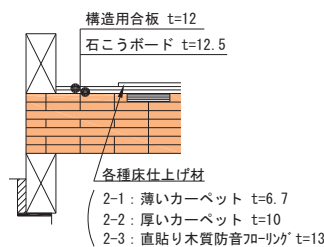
試験体2-1～2-3の断面図 (寸法単位:mm)
